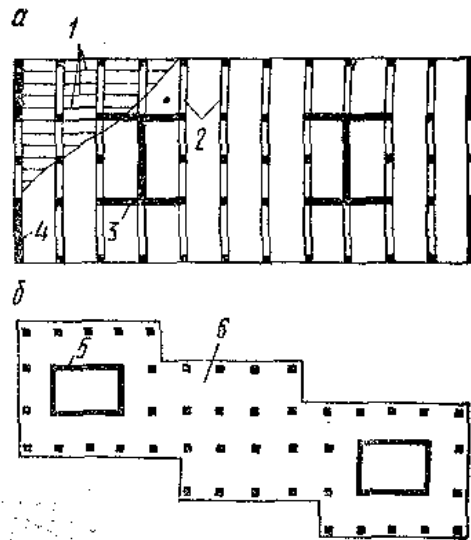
Конструктивные планы многоэтажных каркасных зданий
